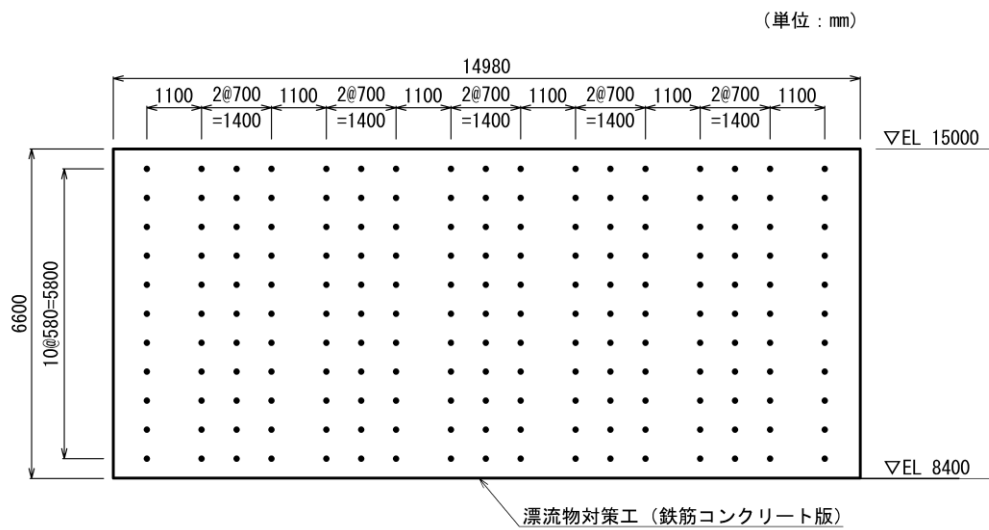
(1) 漂流物対策工 (鉄筋コンクリート版) のアンカーボルト配置図 (正面図)
